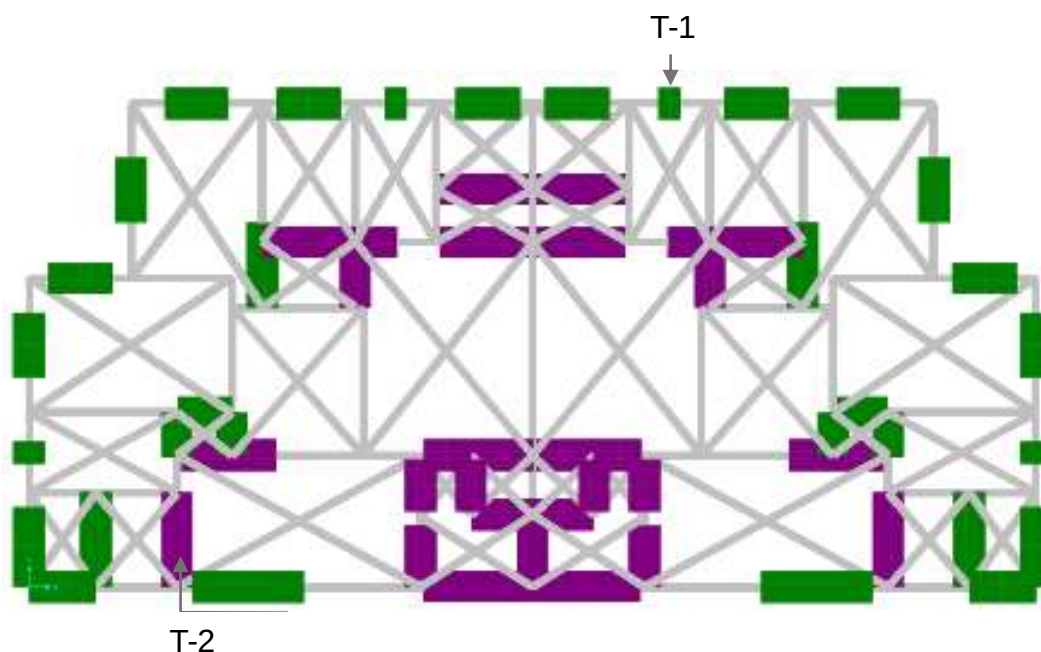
Planta estructural de los modelos MCA-2 y MCA-4.
